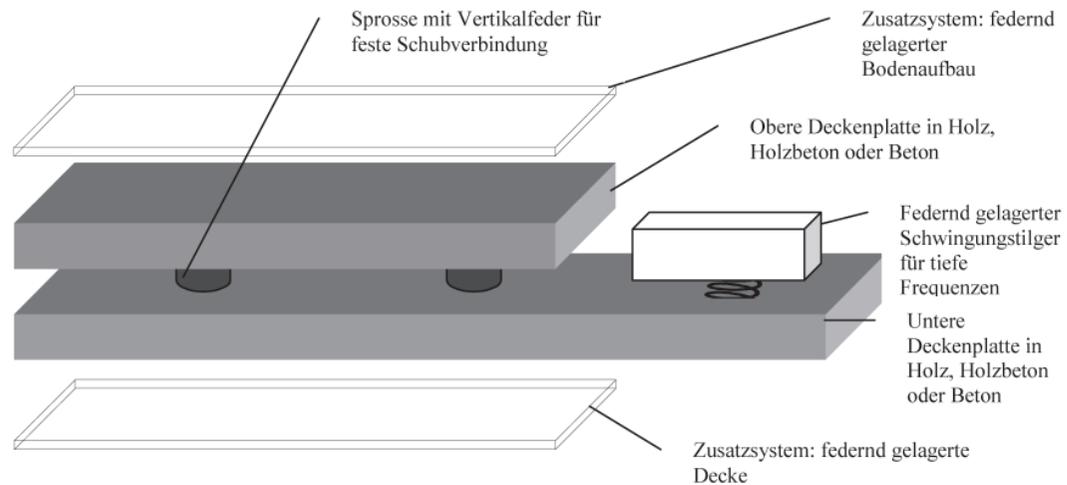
Aufbau der zweischaligen Hybrid-Holzdecke
